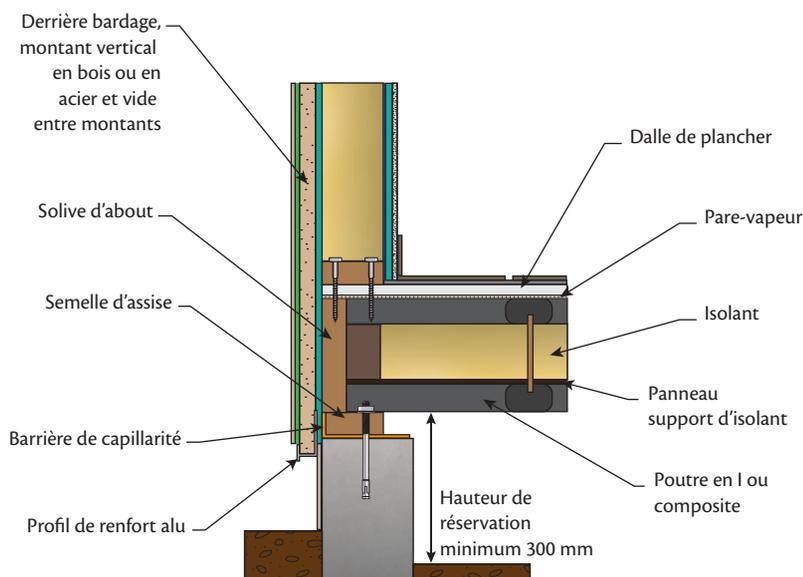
Exemple de pied de façade avec plancher bois sur muret de soubassement
